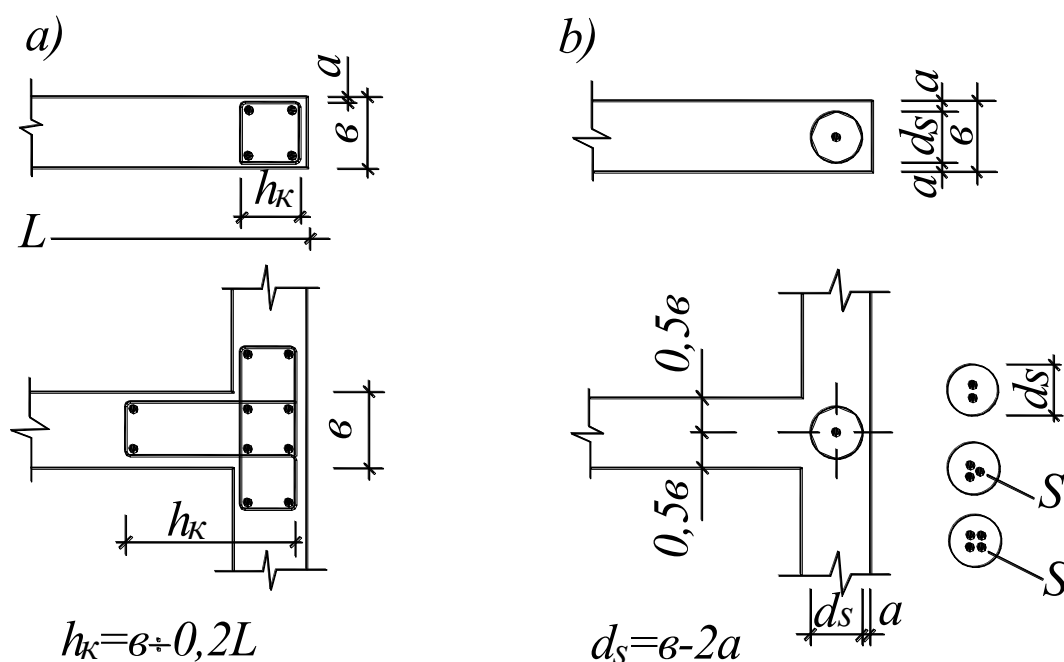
Применяемые на практике (а) и рекомендуемые (б) схемы контурного армирования стен монолитных зданий.
